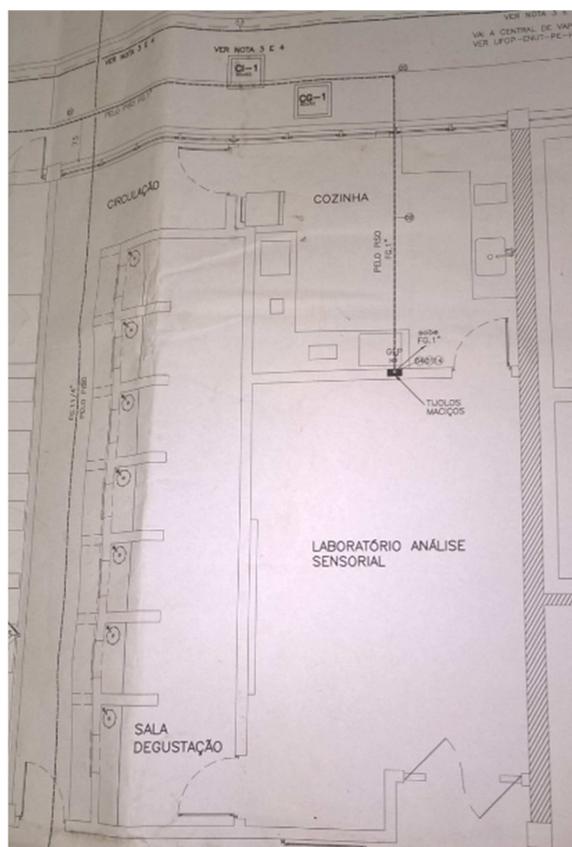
Planta baixa do Laboratório de Análise Sensorial
